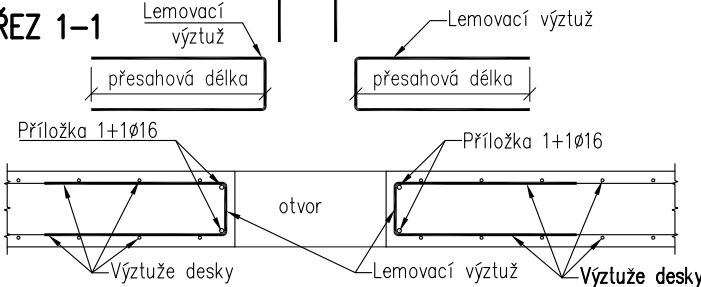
DETAIL LEMOVÁNÍ OTVORU VE STĚNĚ
